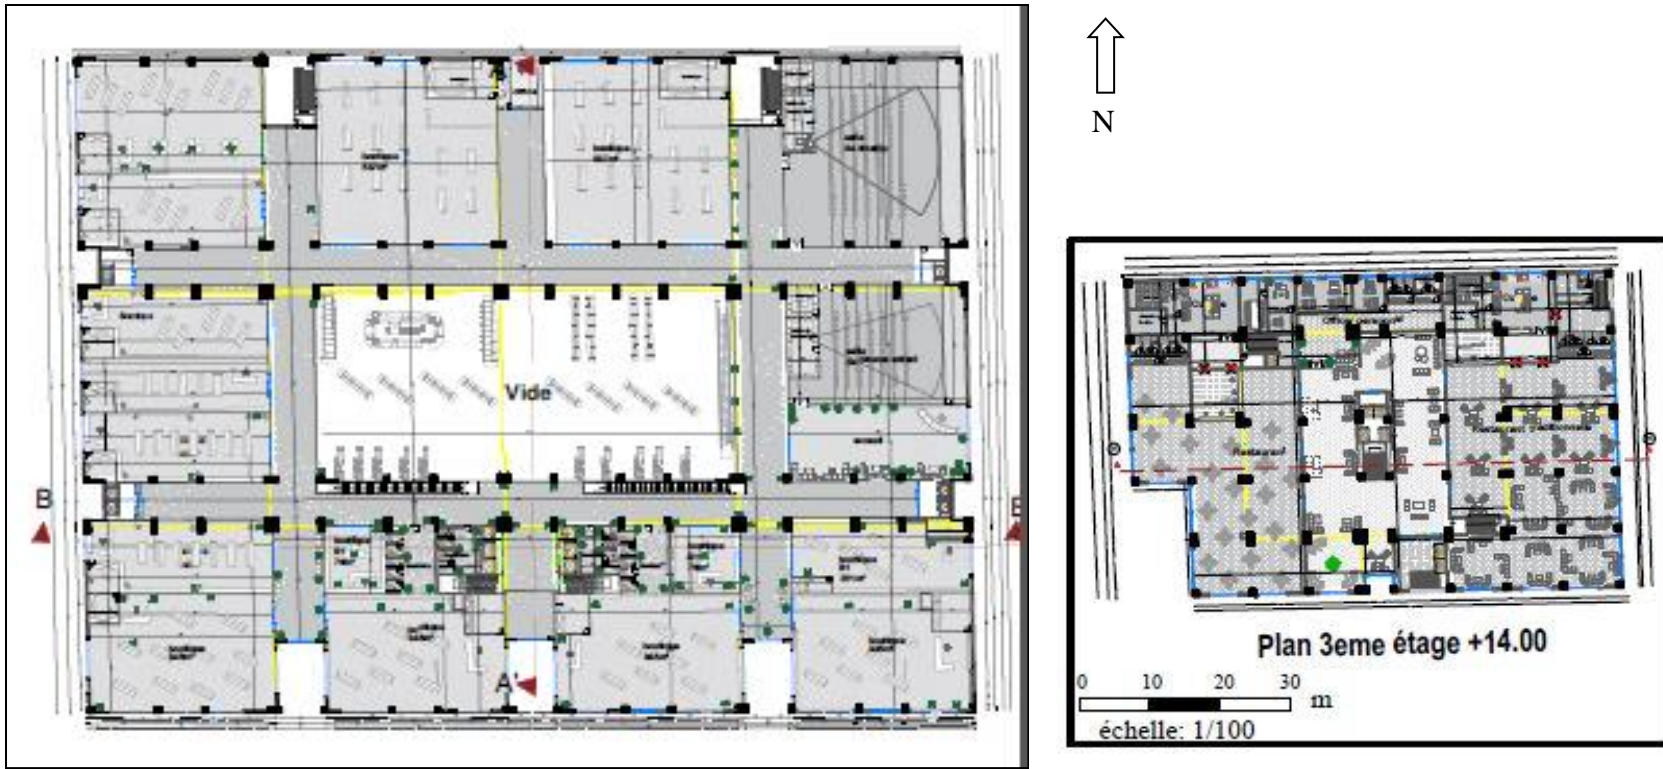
Plan de 3eme étage+16.00/Source : Traiter par l'auteur.
